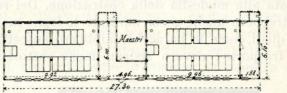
Pianta di una baracca-scuola Döcker a 2 aule.
